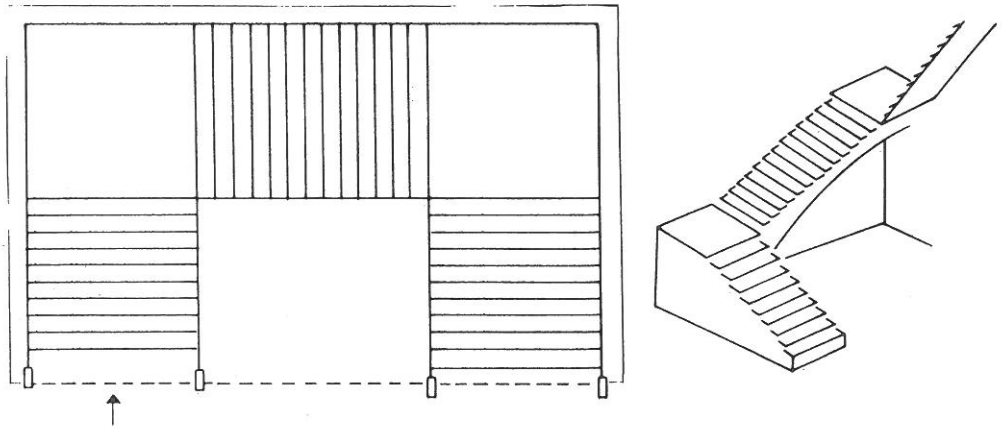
Planta y alzado de la escalera interior del Palacio de los Guzmanes de León.
